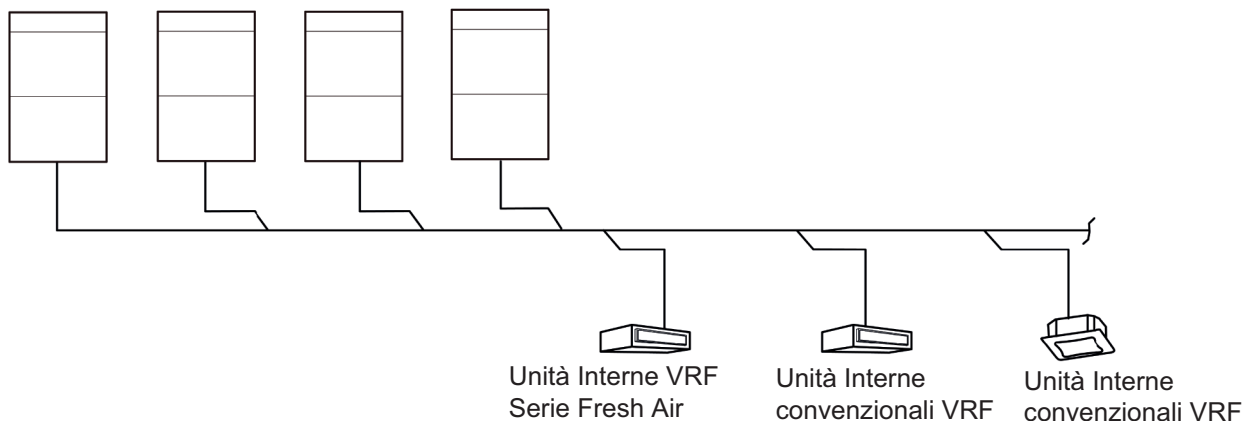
Lo schema di collegamento delle Unità Esterne è modulare
